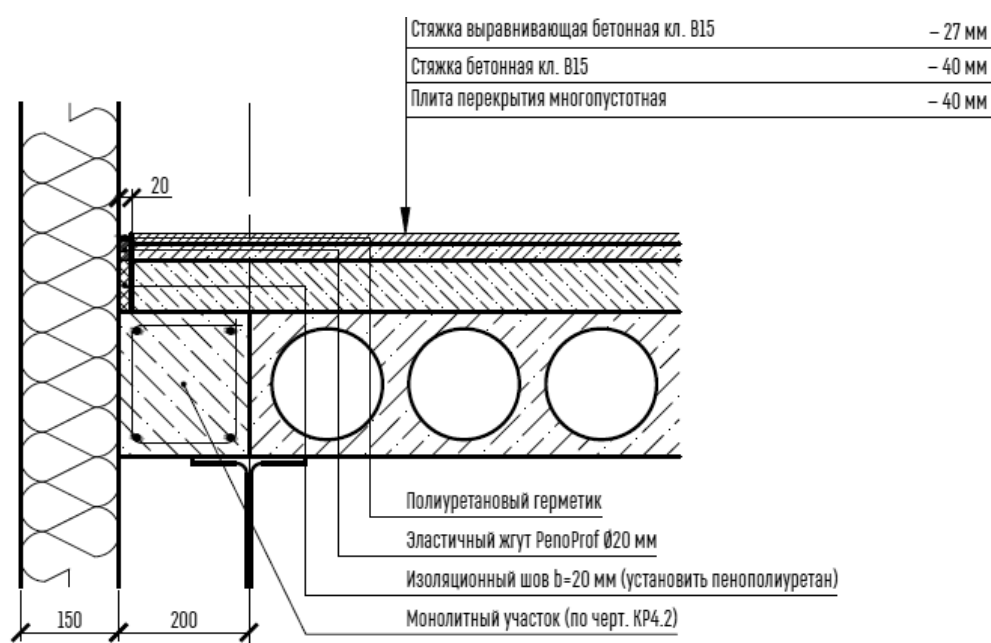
Схема узла опирания панели на полку ригеля.
